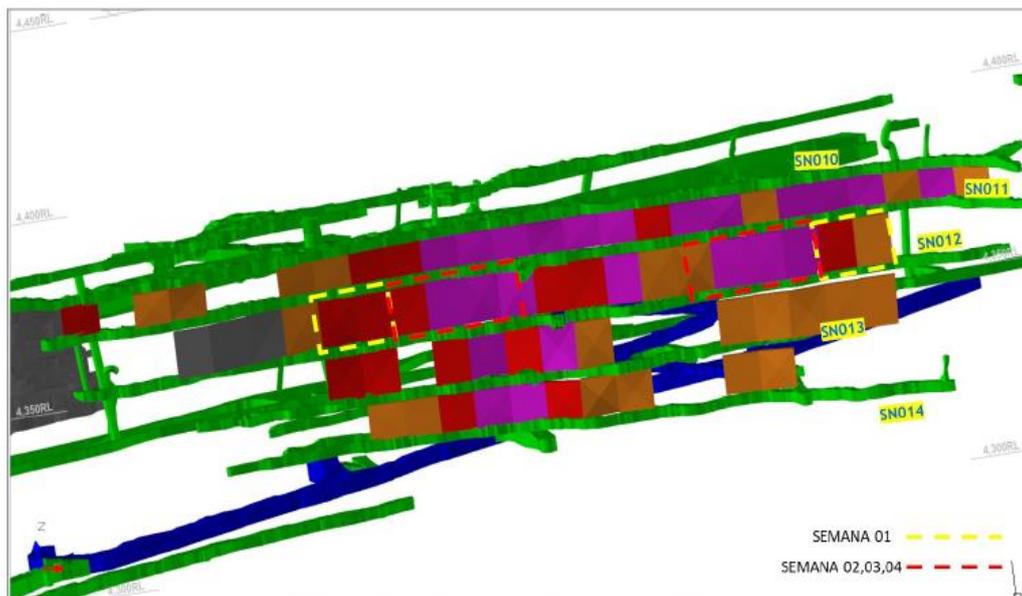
Vista longitudinal 3d proyecto TJ407 SLS
